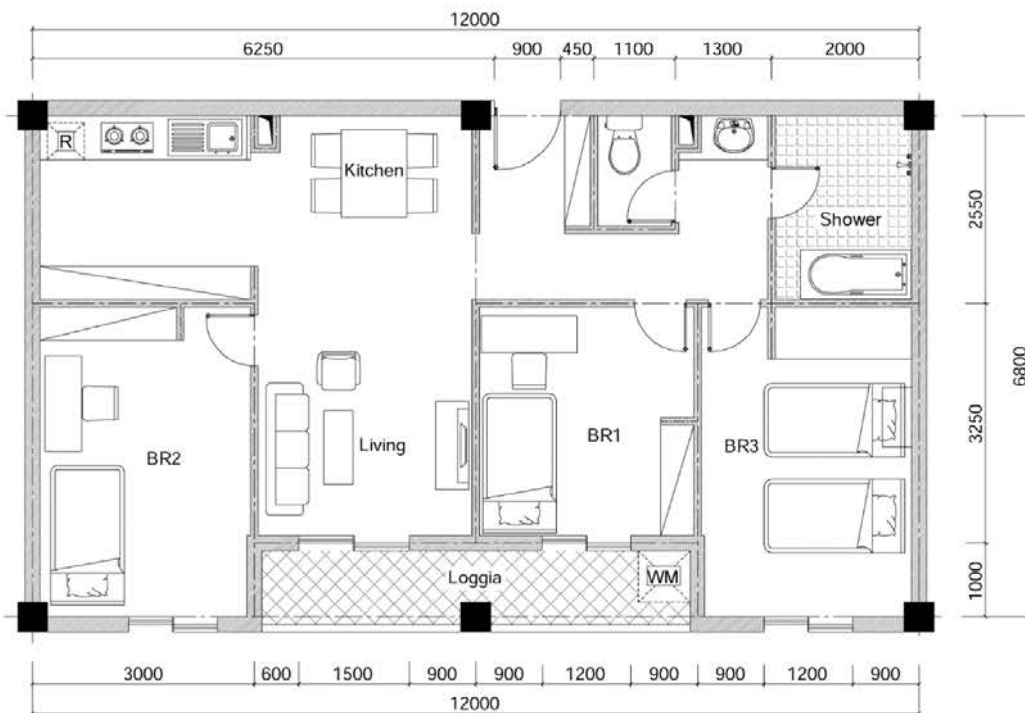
中層住宅住戸平面図 (家族向けタイプ) (将来の改築プラン)
